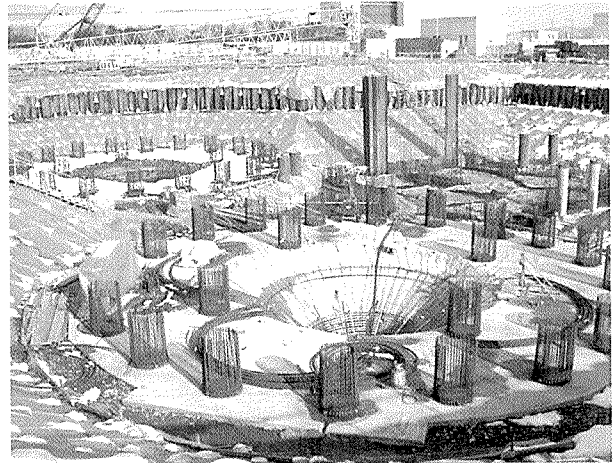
基礎捨てコンクリート打設後の下部円錐部配筋状況
